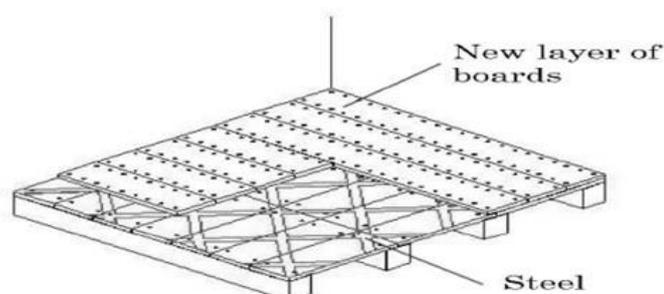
Reforço de pavimento através de chapas metálicas ligadas ao soalho existente
